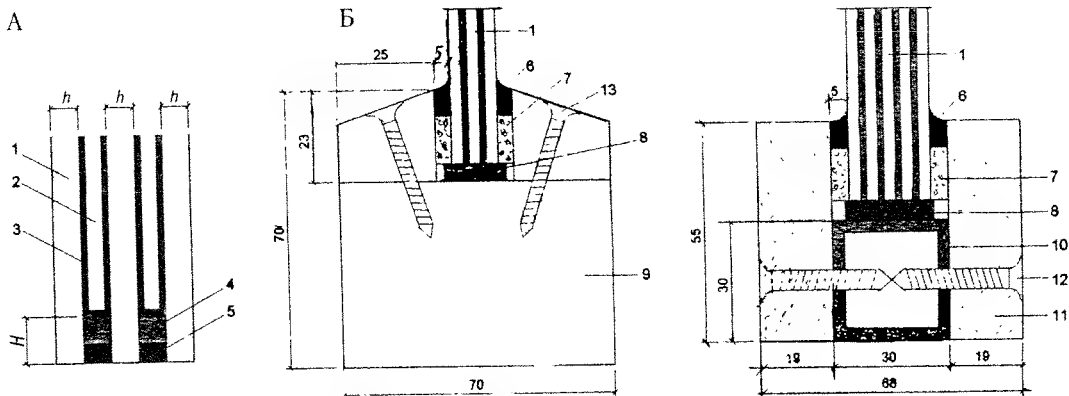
А. Конструкция сопряжения стекол в пожаростойком стеклоблоке Ругобел: h — толщина стекла 4 мм; H — ширина герметизирующего слоя 15 мм, воздушная прослойка 1 мм.
